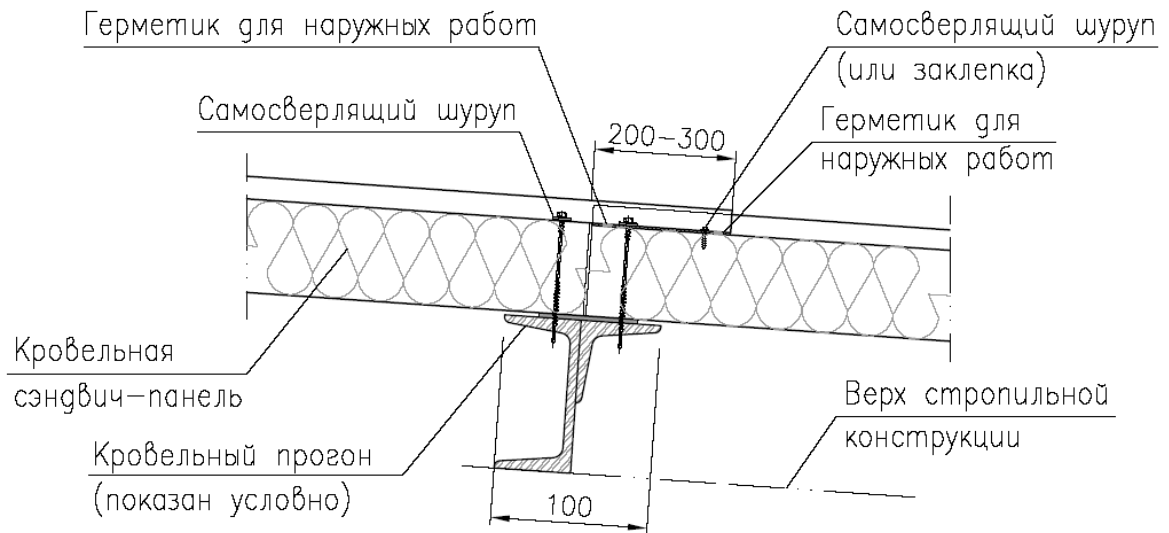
Нахлест кровельных панелей. Окончание монтажа
